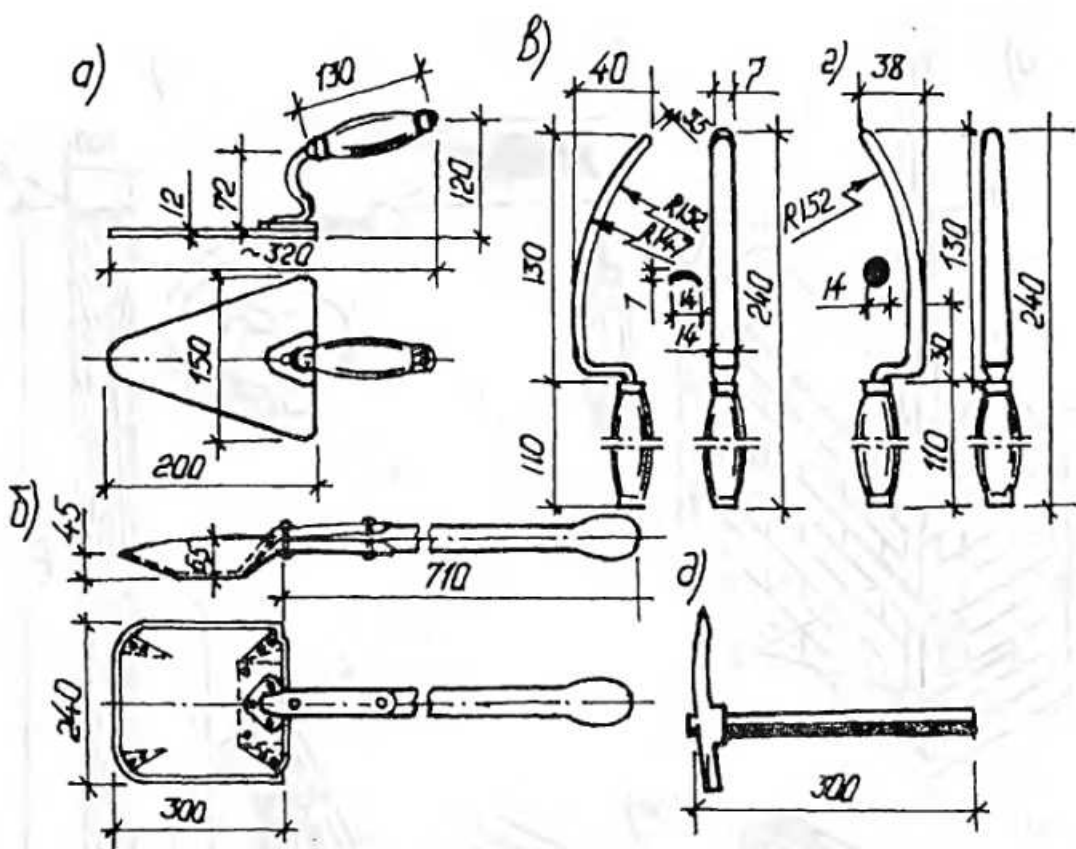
Основний виробничий інструмент муляра: а - кельма; б - ківш-лопата; в,г - розшивки відповідно для випуклих і увігнутих швів; д - молоток
